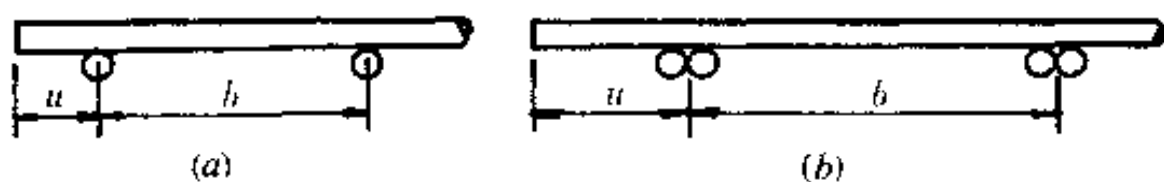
焊接网纵向钢筋和横向钢筋
